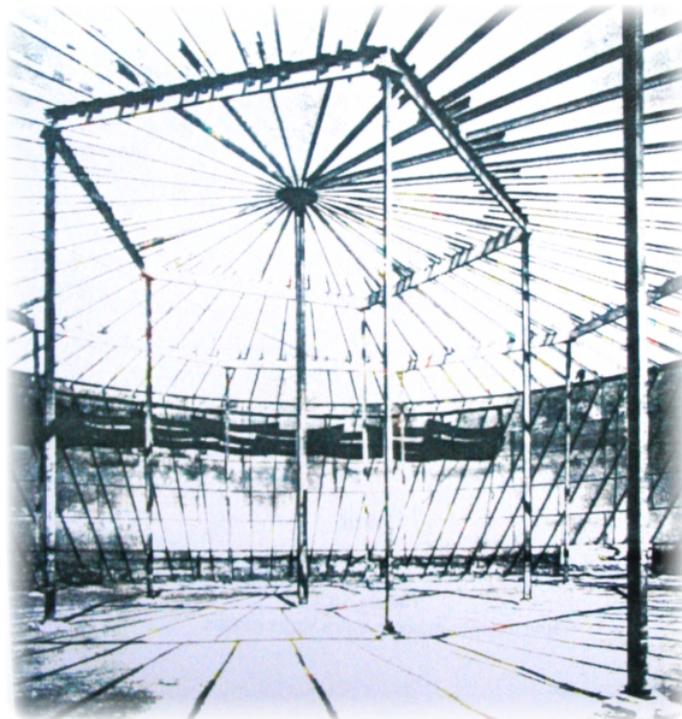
Teto côncavo suportado. Componentes da estrutura de sustentação. Vigas radiais, vigas transversais e colunas
